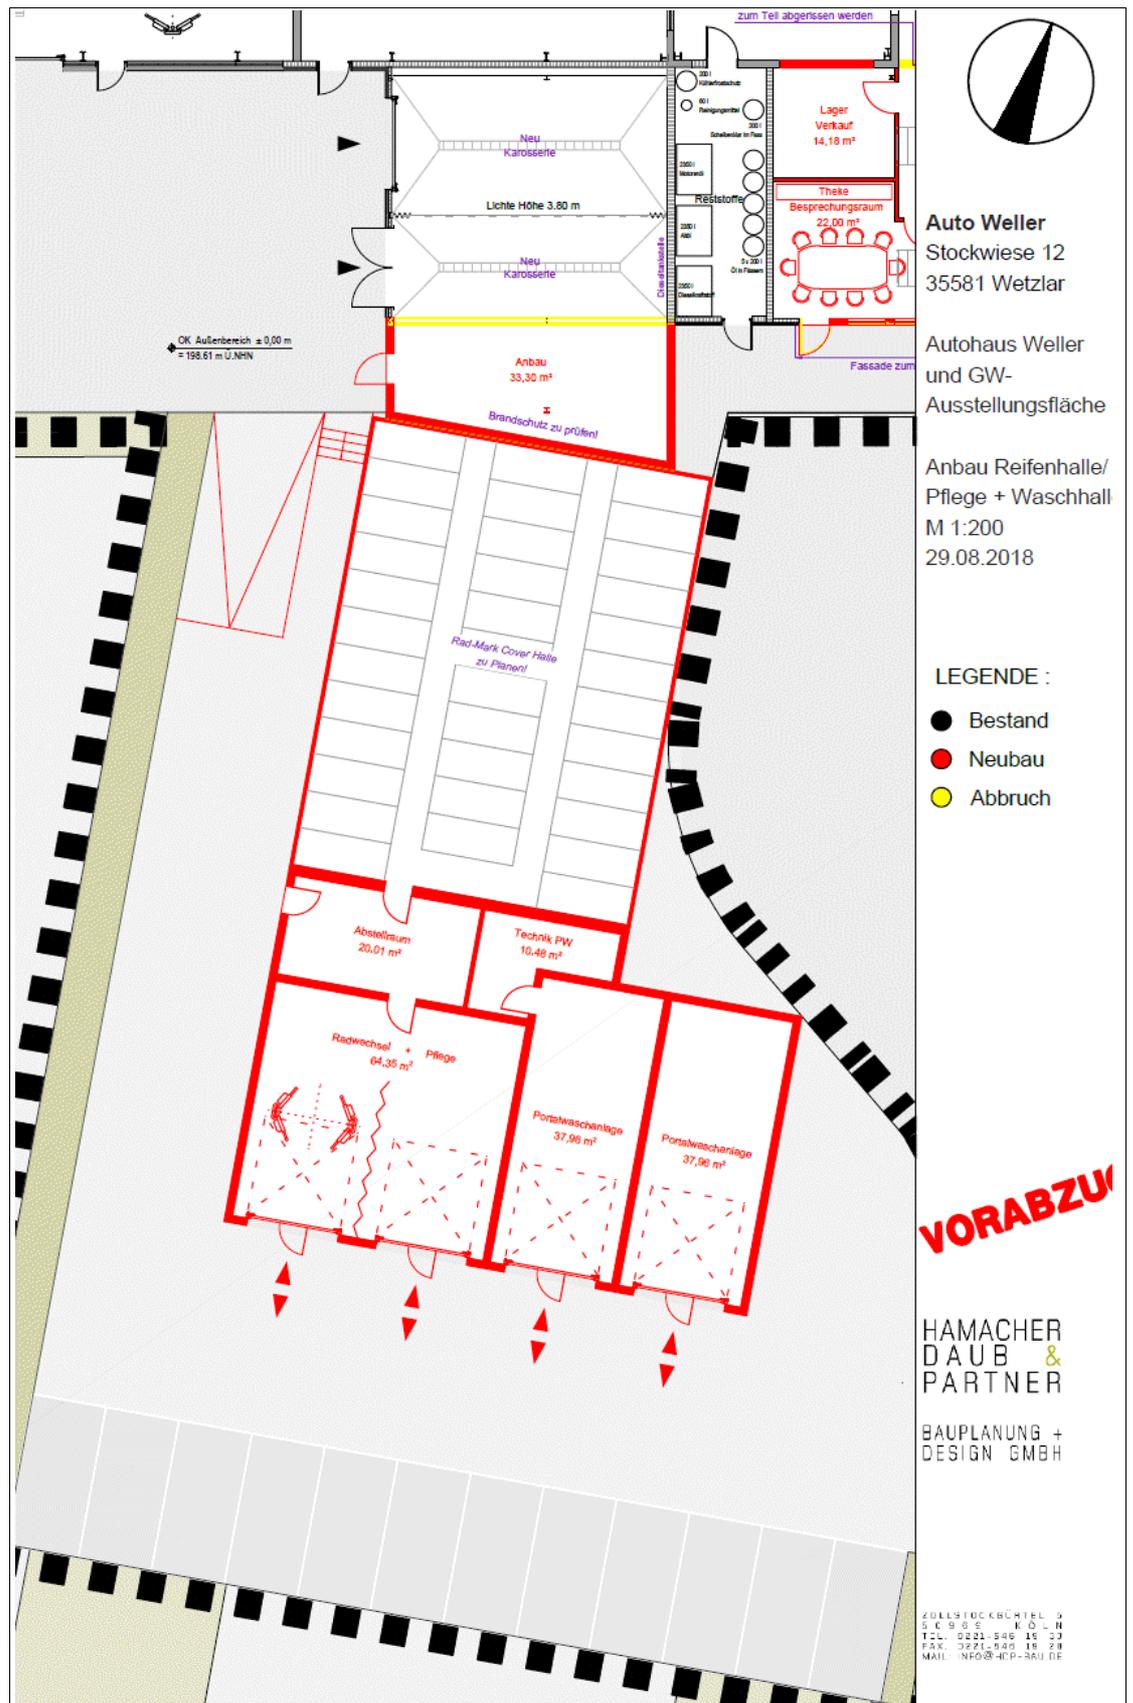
Grundriß Anbau Pflege + Waschhallen.
